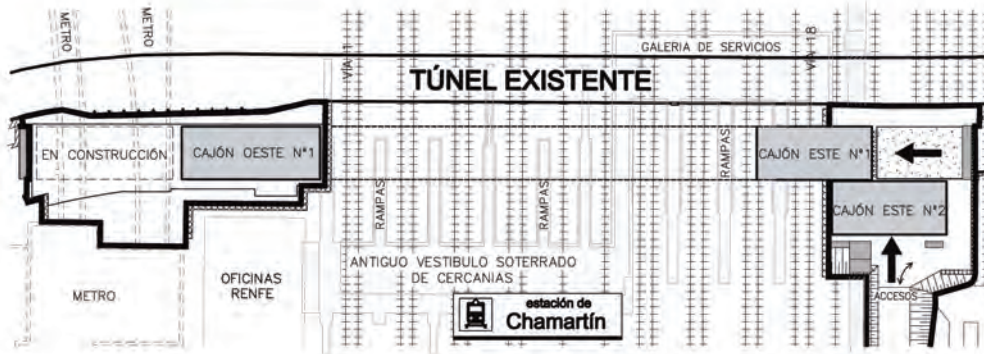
Cajones empujados. Planta Empuje Este / East jacking.
